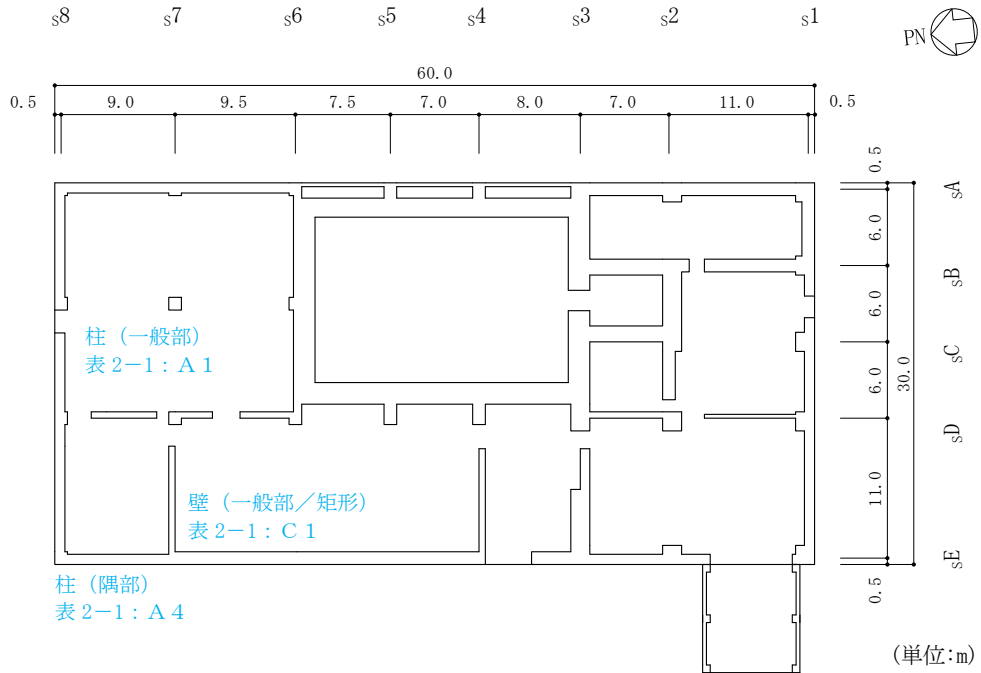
サイトバンカ建物の概略平面図 (EL 8.8m)
